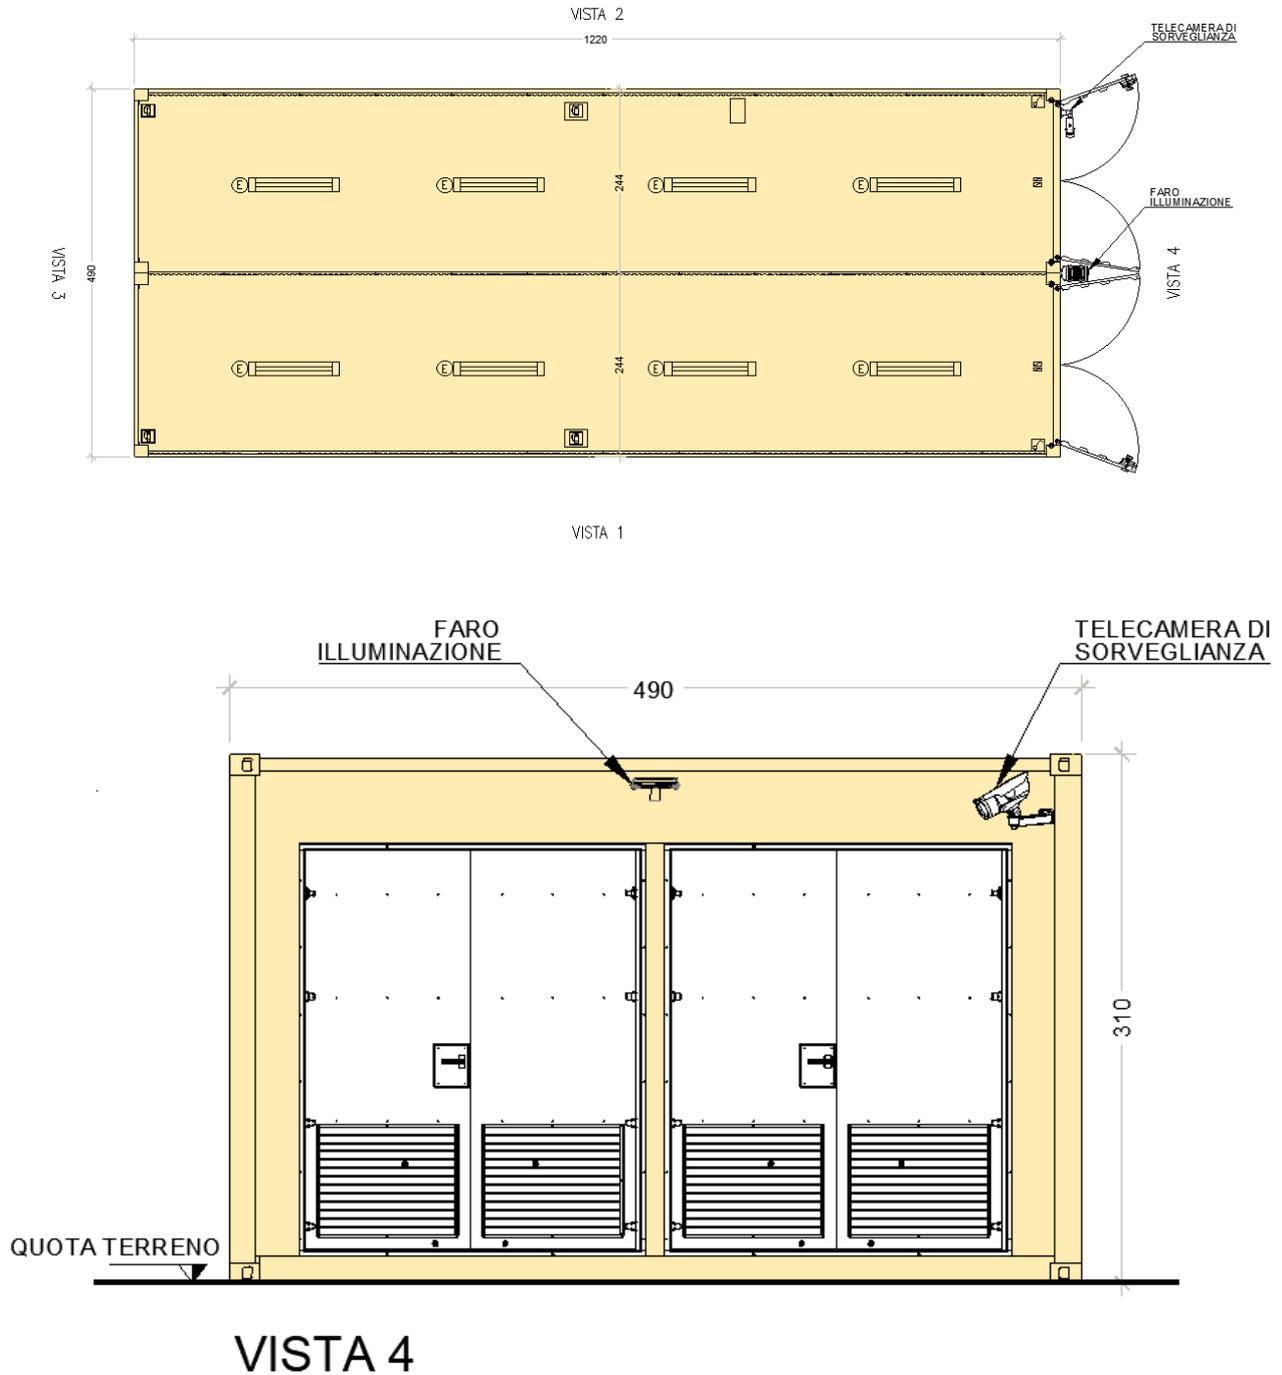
Pianta e prospetti della cabina magazzino con illuminazione e videosorveglianza
